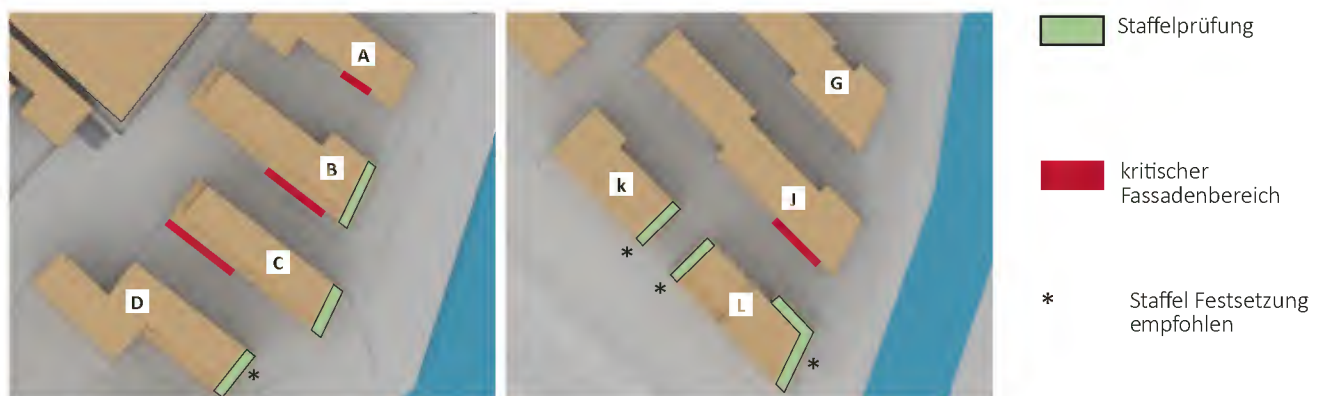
geprüfte Staffelgeschosse der Gebäude B-D
